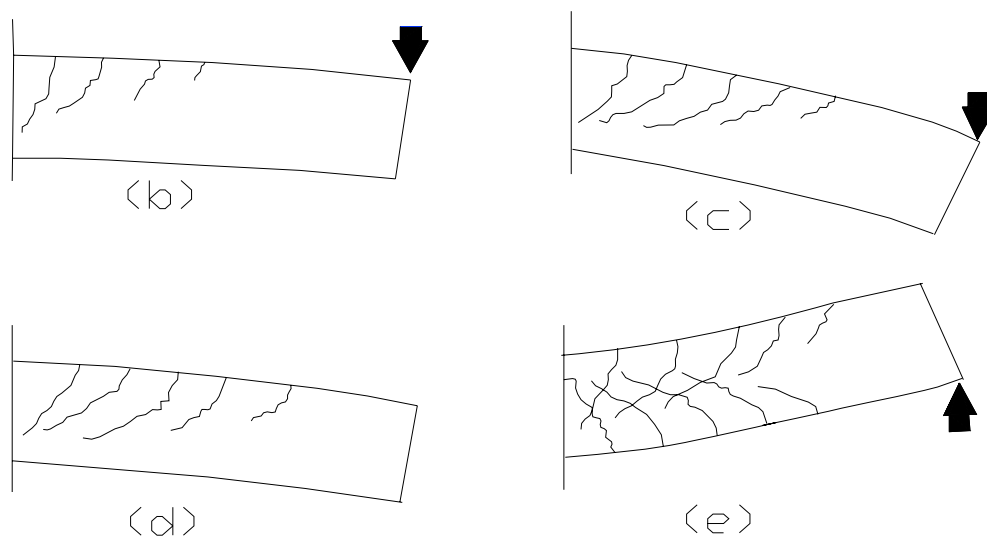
Agrietamiento de las vigas en voladizo
